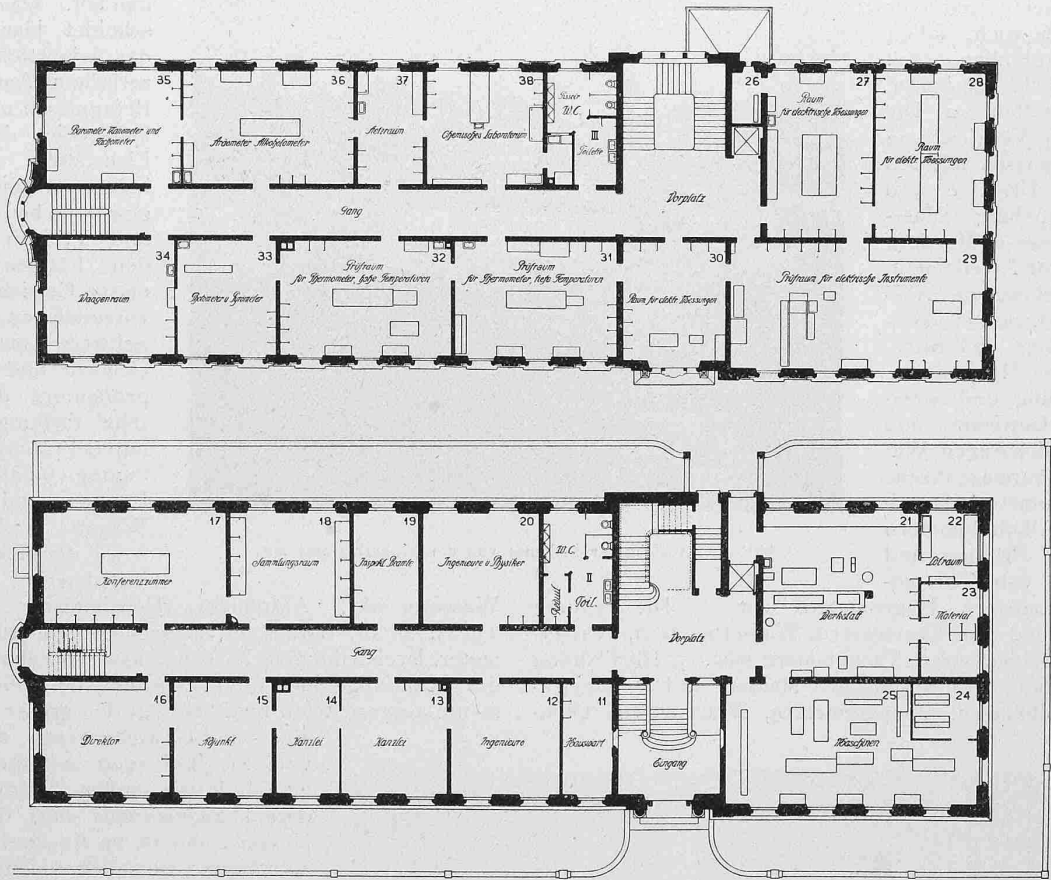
und 5. Schweiz. Amt für Mass und Gewicht in Bern. — Grundrisse vom Erdgeschoss und I. Stock. — 1:400.
